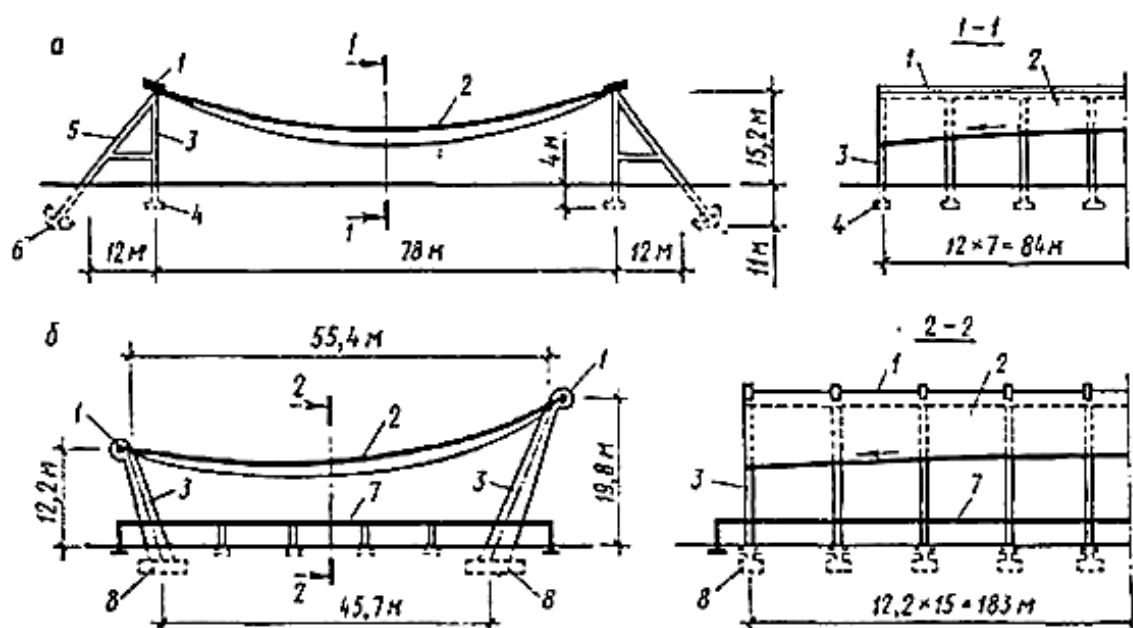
Висячие оболочки на прямоугольном плане:
